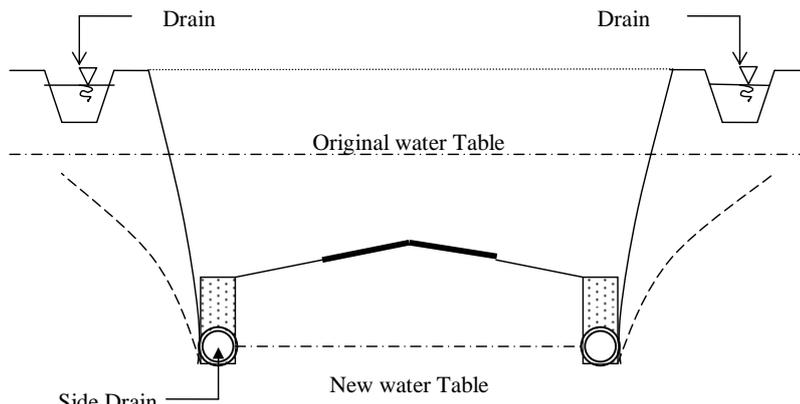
Denah System of LATERAL & LONGITUDINAL DRAINS
